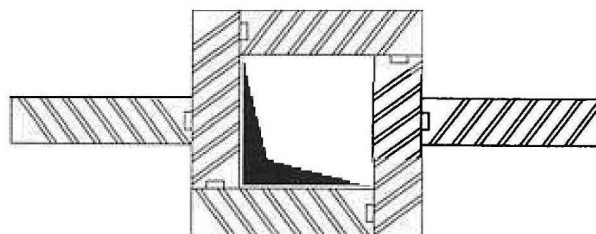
Aansluiting aan het plafond en aan de vloeren
